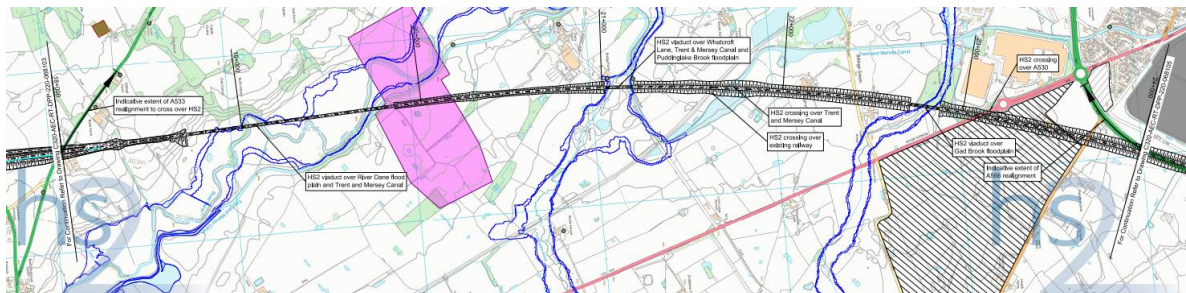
Planta do traçado viaduto sobre os rios Trent, Dane e Mersey Canal (Unido, HS2 Phase 2b: Chorlton to Winterbottom route sheet 4).
